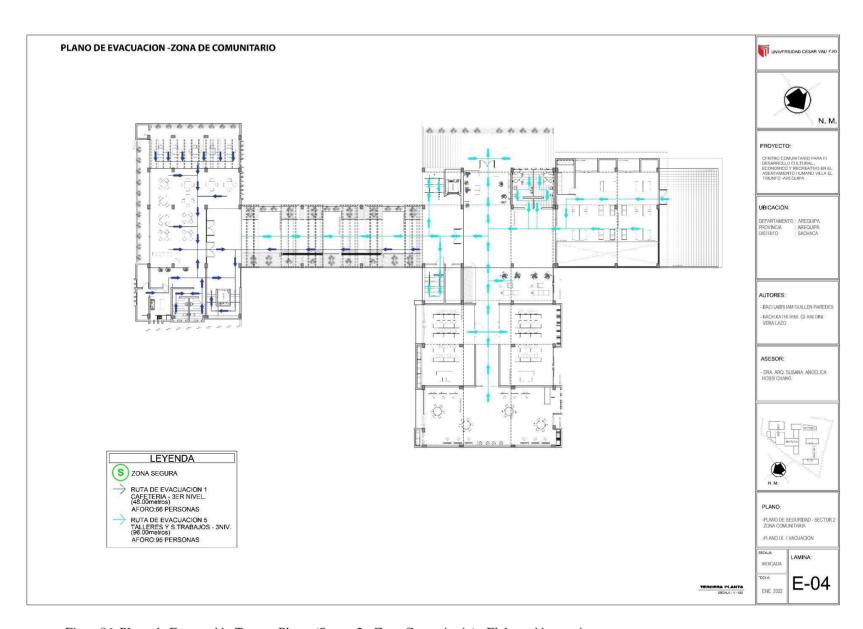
Plano de Evacuación Tercera Planta (Sector 2 - Zona Comunitaria) - Elaboración propia
